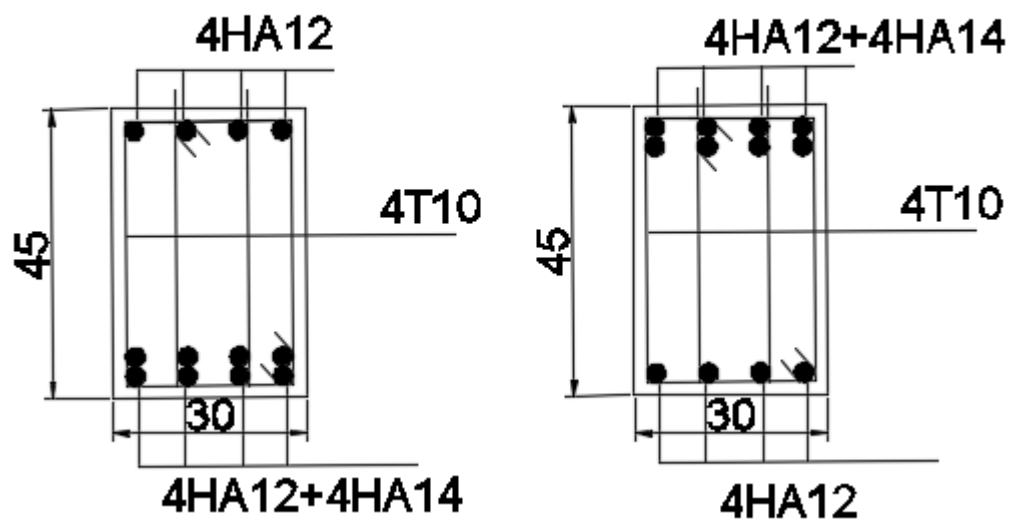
schéma de ferrailage de la poutre secondaire
